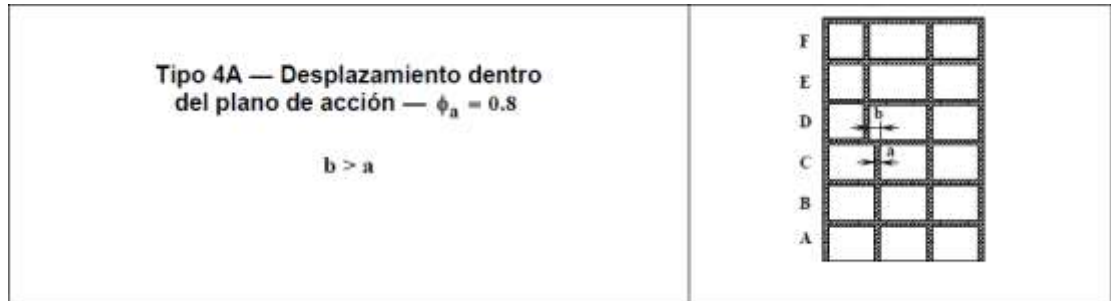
Desplazamiento dentro del plano de acción.
